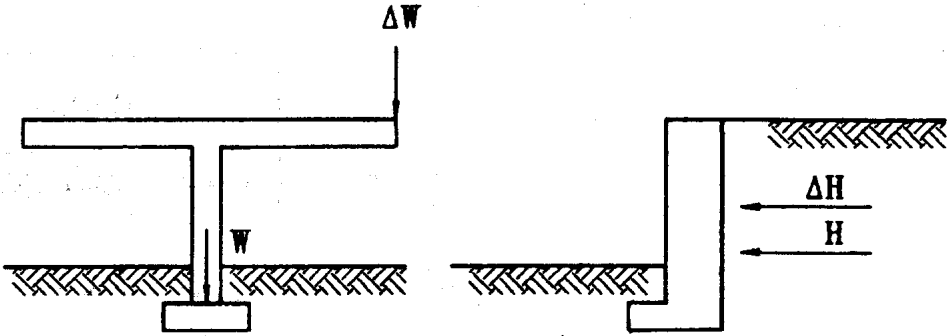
الأجزاء من مساحة الأساسات التي تعمل في نقل الأحمال من الأساس إلى التربة
